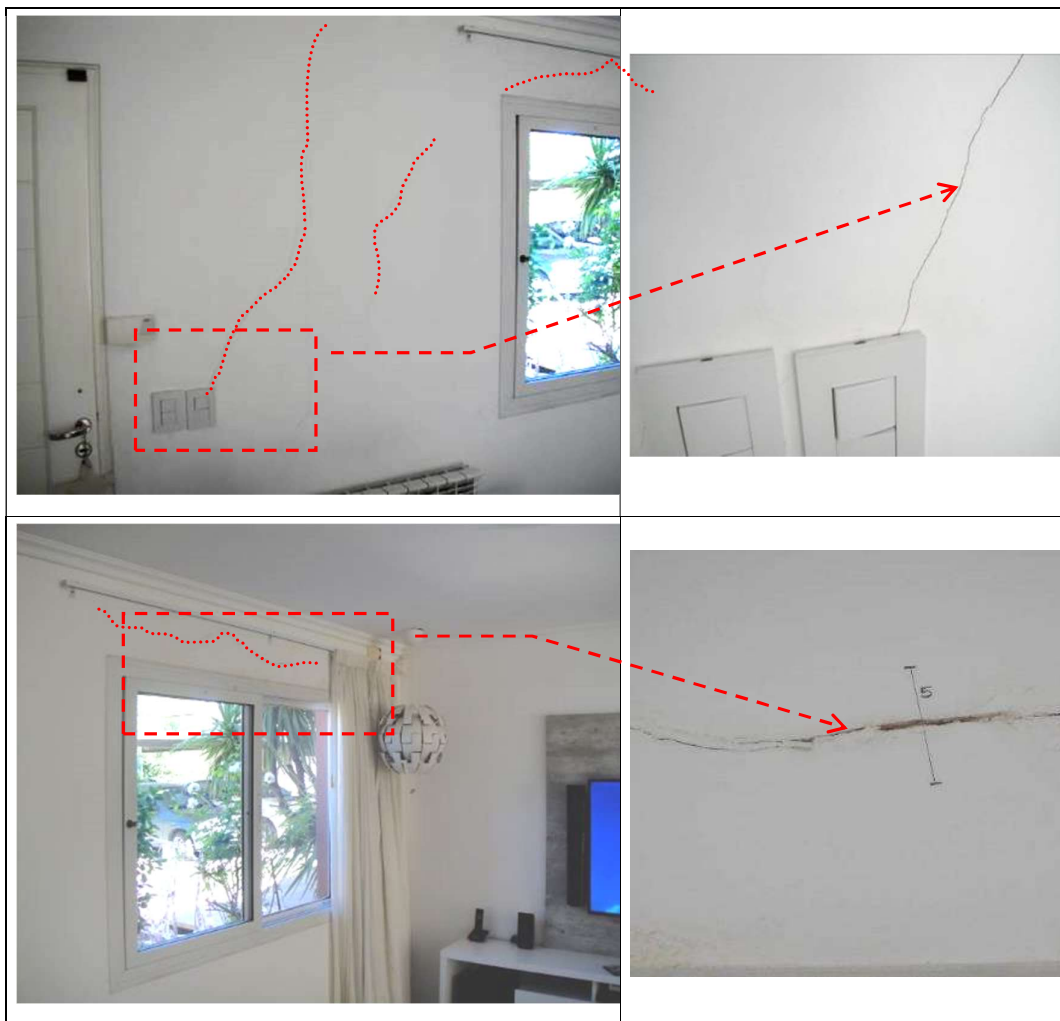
Agrietamiento en muro de fachada desde el interior - Living
